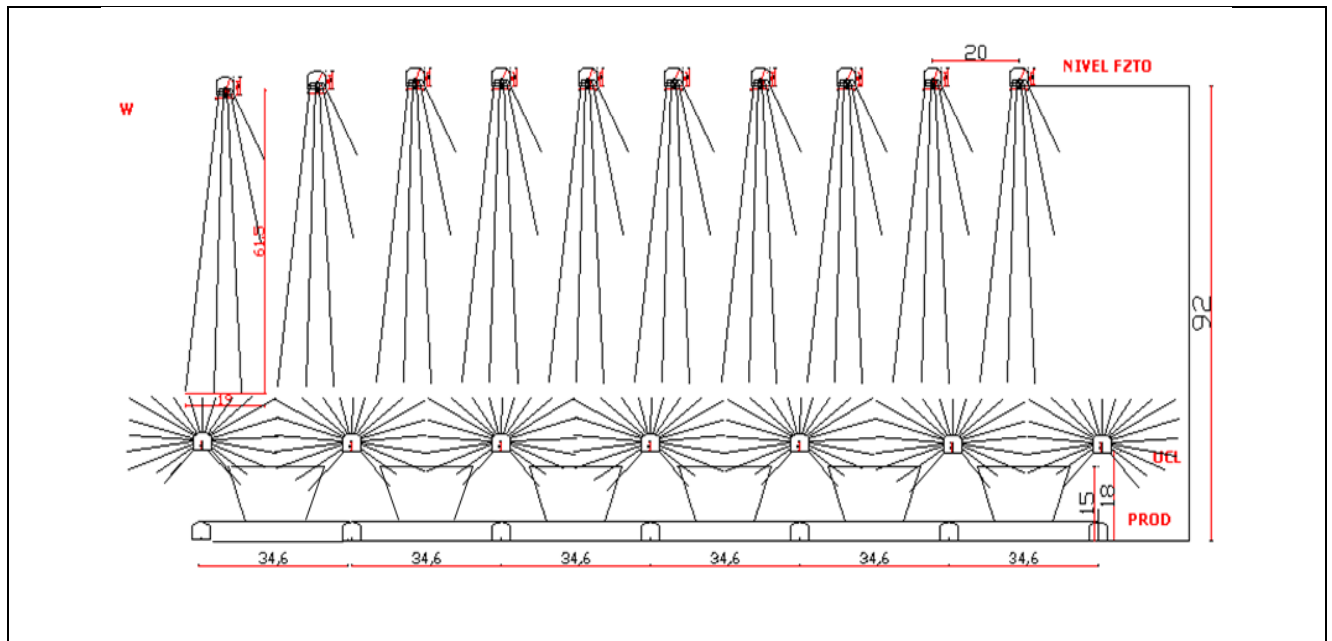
Vista en planta de la disposición y geometría del nivel de forzamiento
